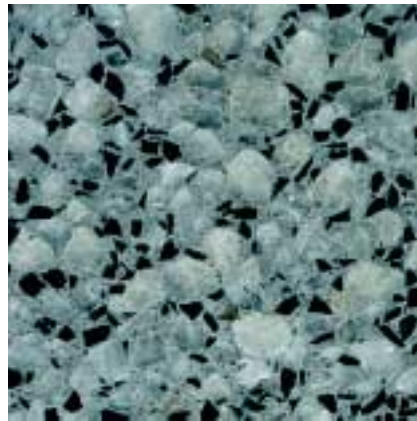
Polierte Betonoberfläche, heller und dunkler Zuschlag, weißer Zement
